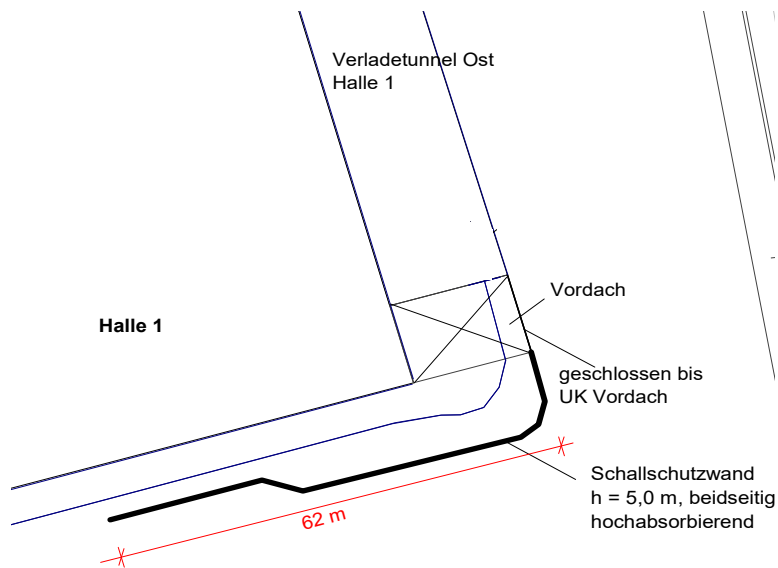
Grundriss Schallschutzwand südlich Halle 1
